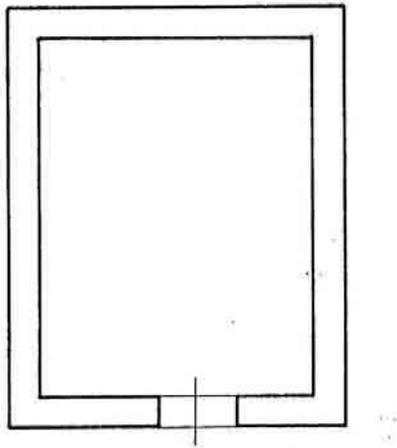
Planimetria dell'immobile fg.98 part. 404 sub.1 come da perizia del C.T.U. Cicero
